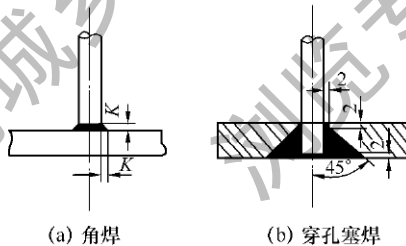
预埋件钢筋电弧焊 T 形接头
